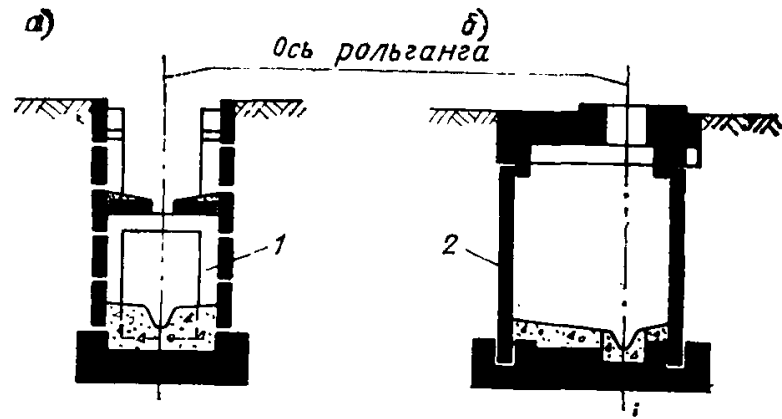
Фундаменты под вспомогательное оборудование (рольганги), совмещенные с тоннелем гидросмыва окалины в сборно-монолитном железобетоне
